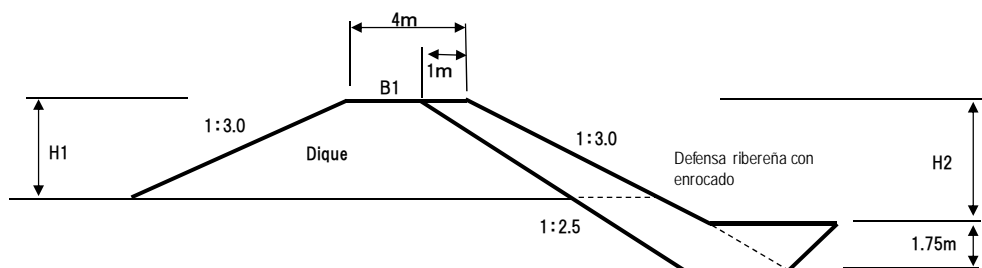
Plan de construcción de diques en el Río Majes-Camaná
